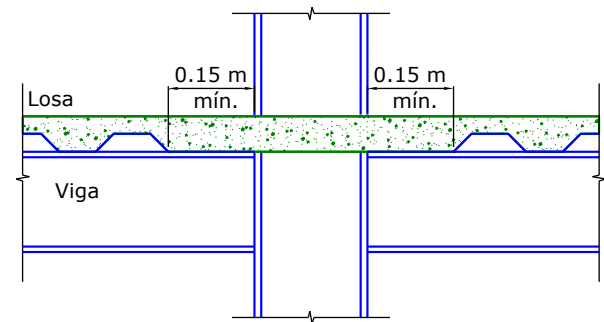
Condición de losa maciza alrededor de la columna de acero (por simplicidad no se muestran los componentes de la conexión viga-columna).
